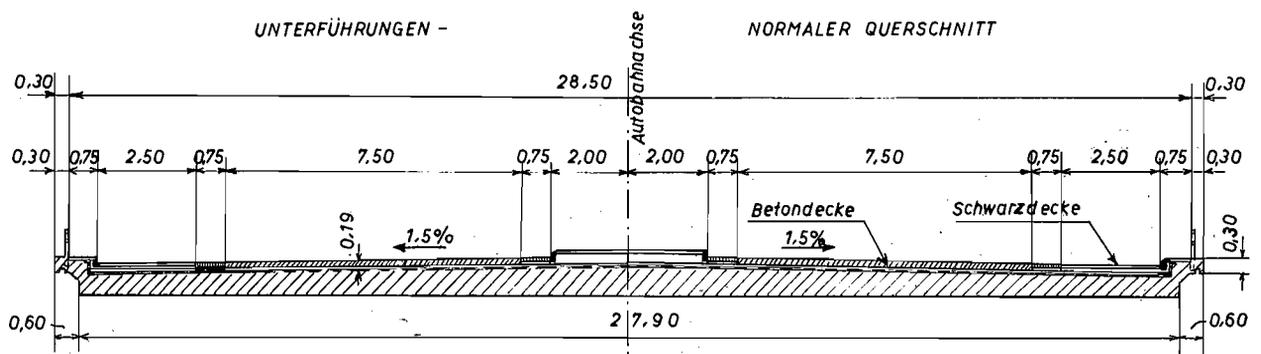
Normaler Querschnitt von Autobahnbrücken im Zuge der Autobahn Wien-Salzburg
